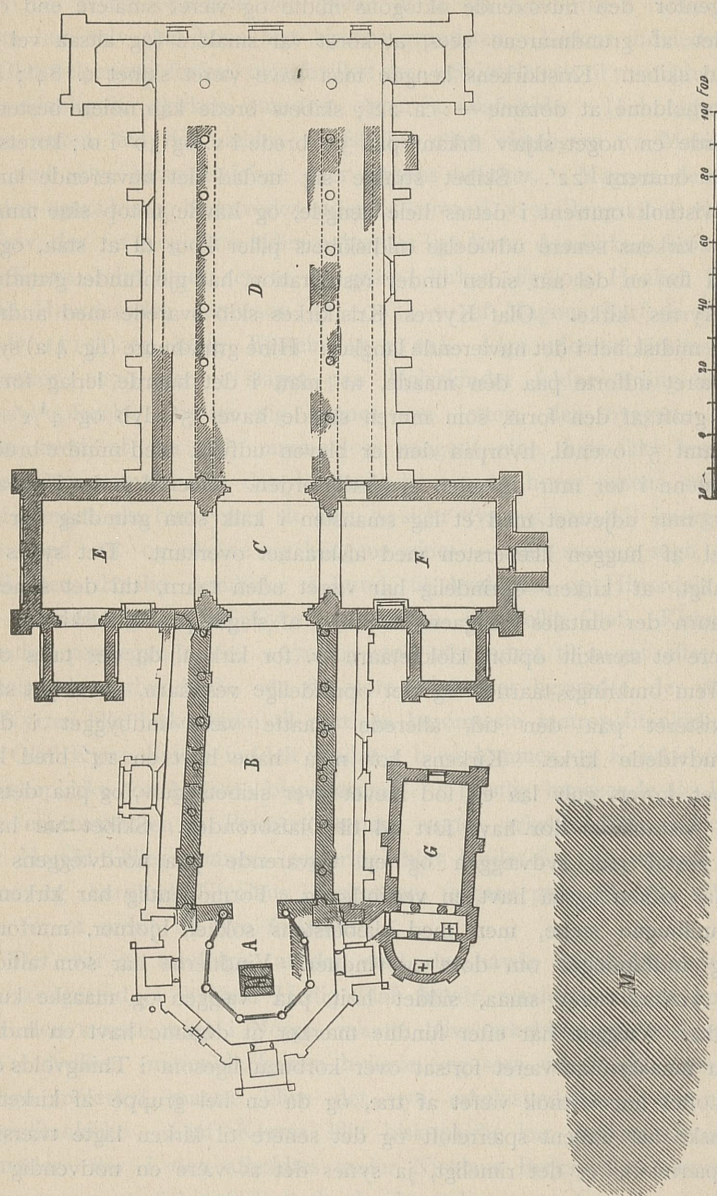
Trondhjems domkirke: Grundmurene i grundrids.
